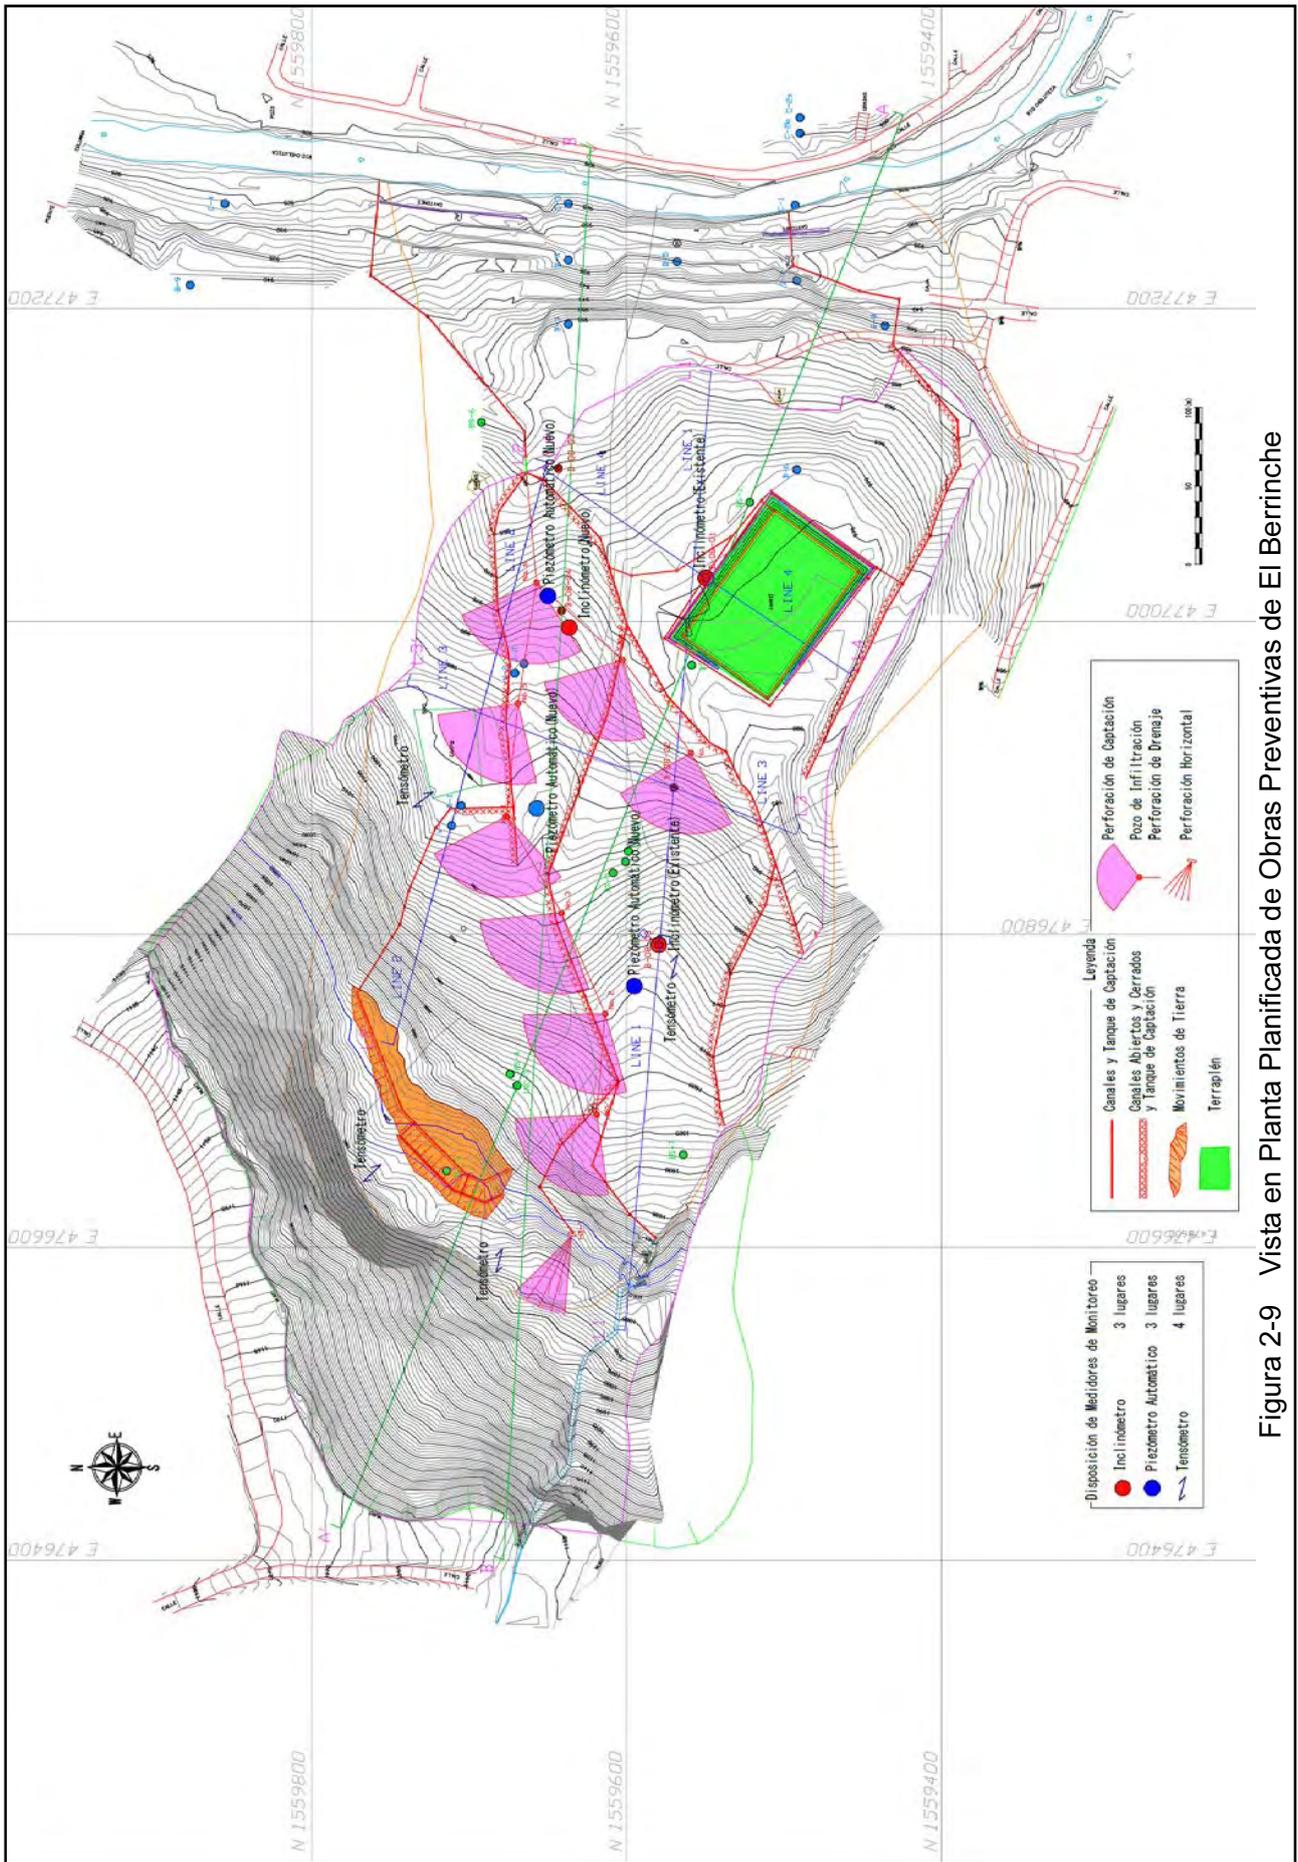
Vista en Planta Planificada de Obras Preventivas de El Berrinche
